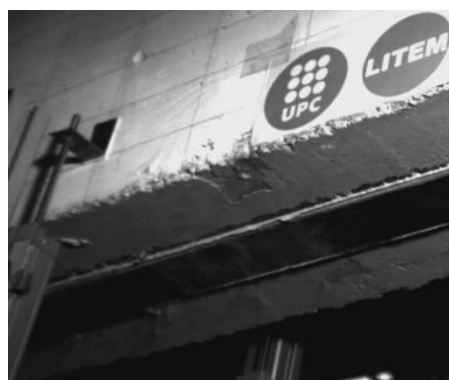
a) Tipo de falla en ensayo de viga CG04
